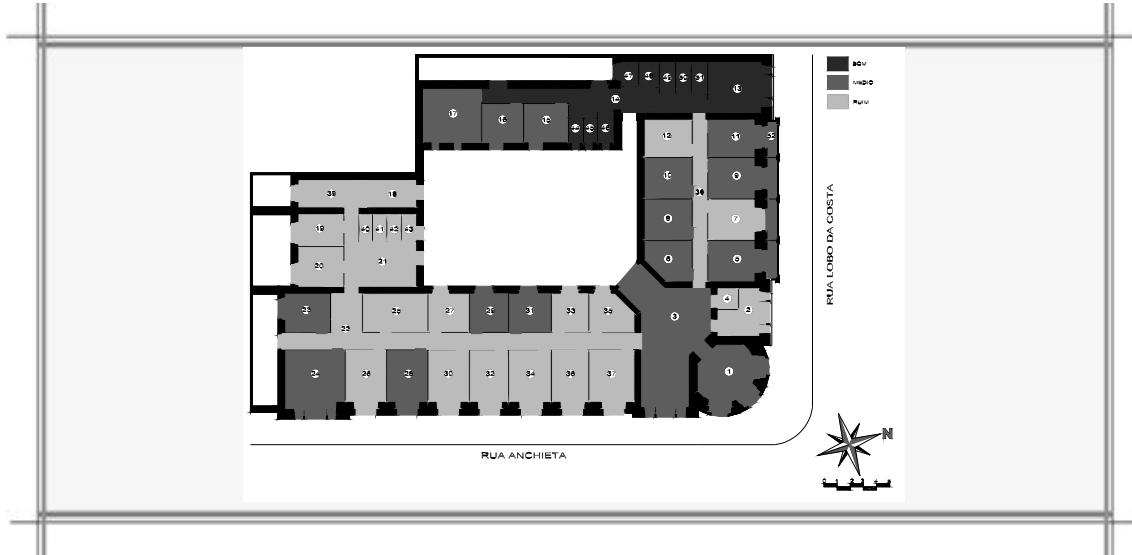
Planta Baixa do 4º Pav. – Estado de Conservação. Desenho: Cristiane Müller.
